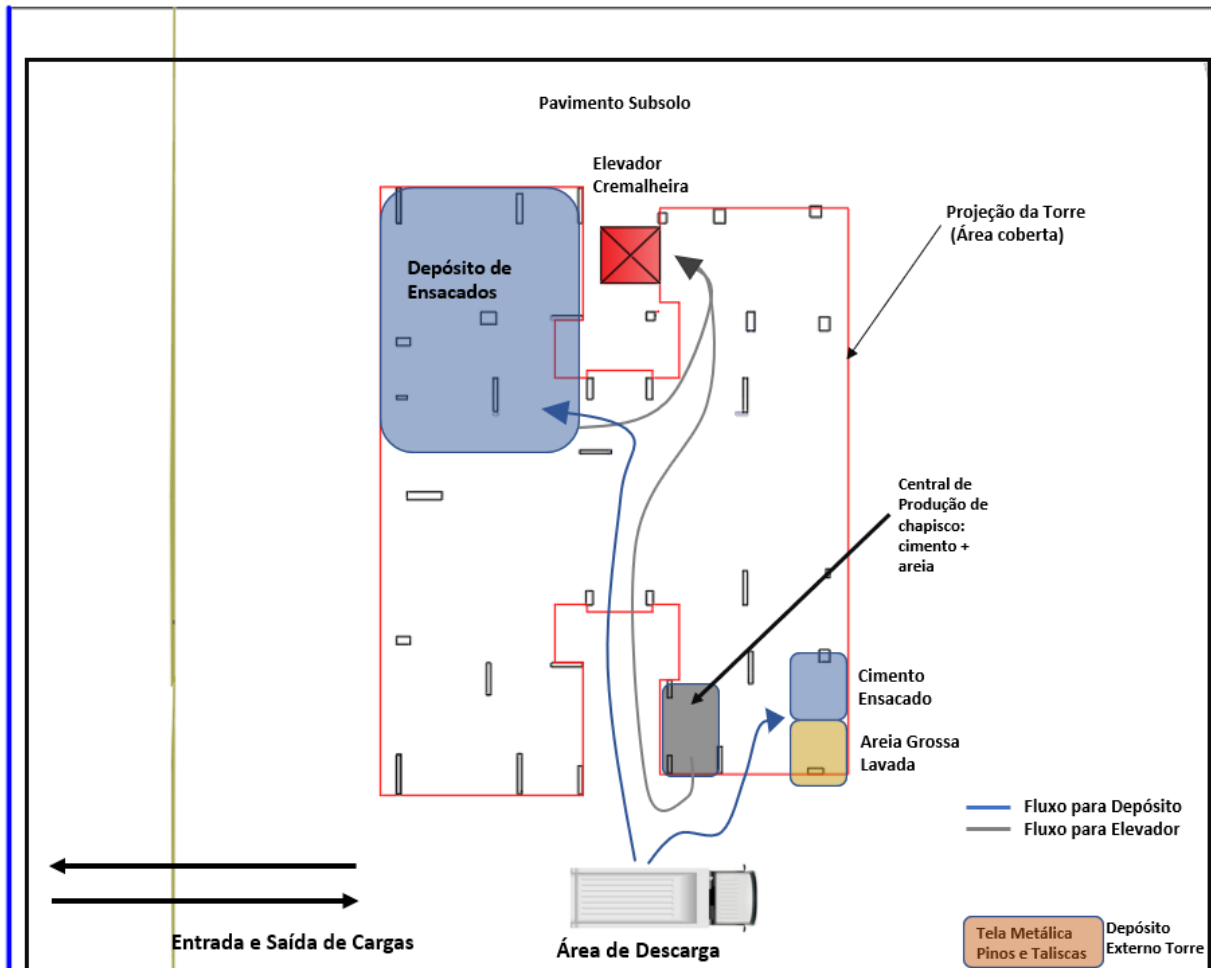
Apresentação do pavimento subsolo. (fonte: elaborado pelo autor)
